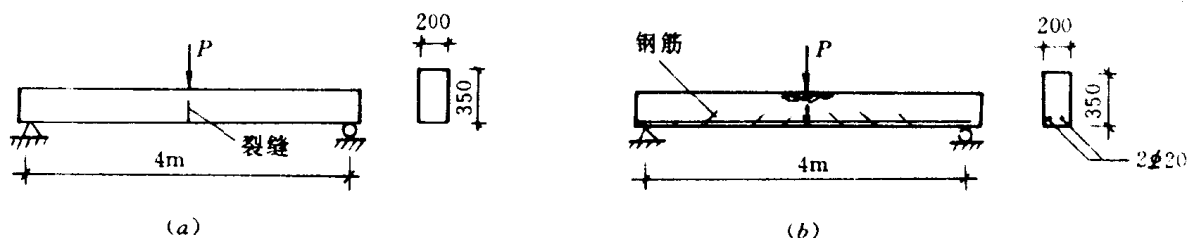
素混凝土梁与钢筋混凝土梁破坏情况对比
